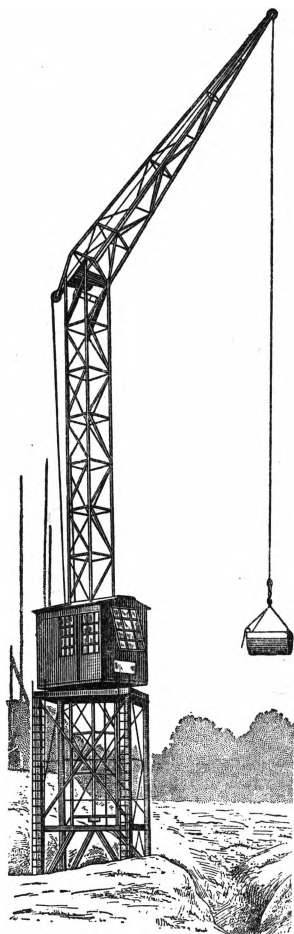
Передвижной электрический башенный кран для строительных работ.
